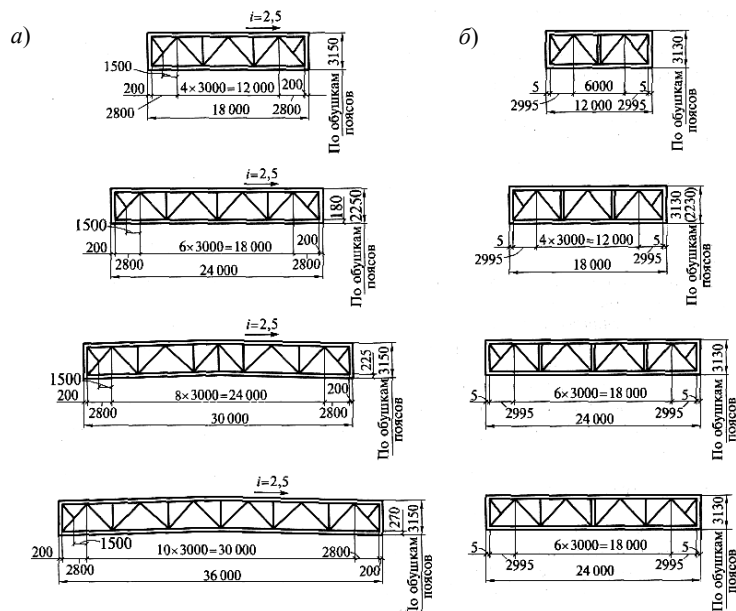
Типовые схемы стропильных (а) и подстропильных (б) ферм для покрытия с уклоном кровли 2,5 %
